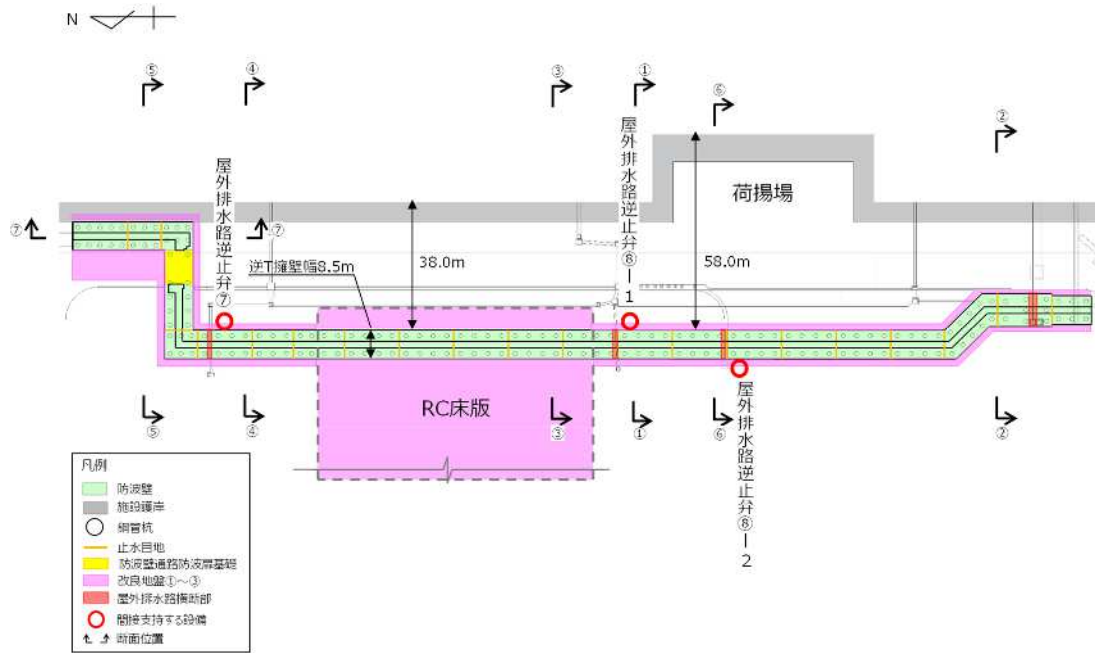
防波壁（逆 T 擁壁）平面配置図
